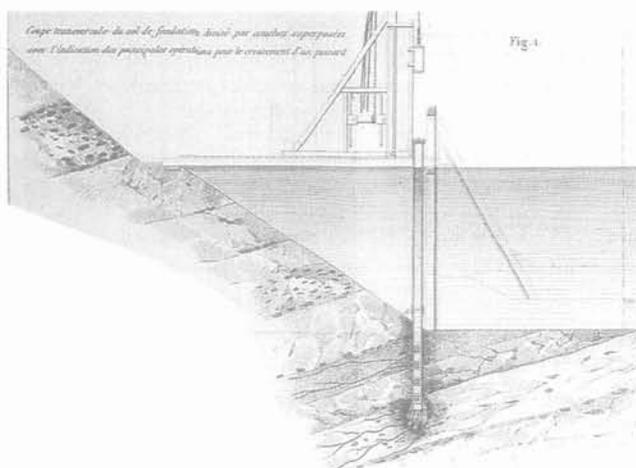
Puisard d'éventation figurant sur une planche de l'ouvrage de Beaudemoulin, 1829.
